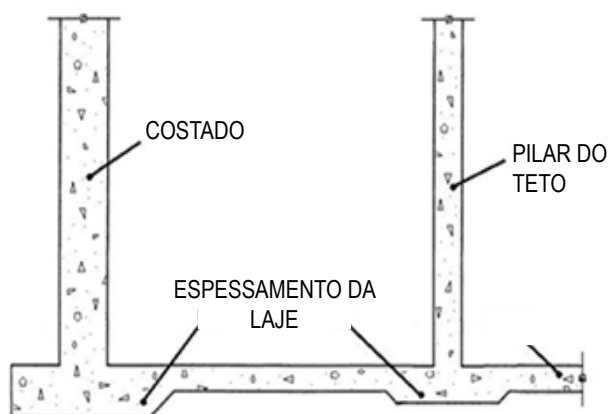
Corte esquemático demonstrando o espessamento da laje de fundo em regiões sujeitas a punção.
